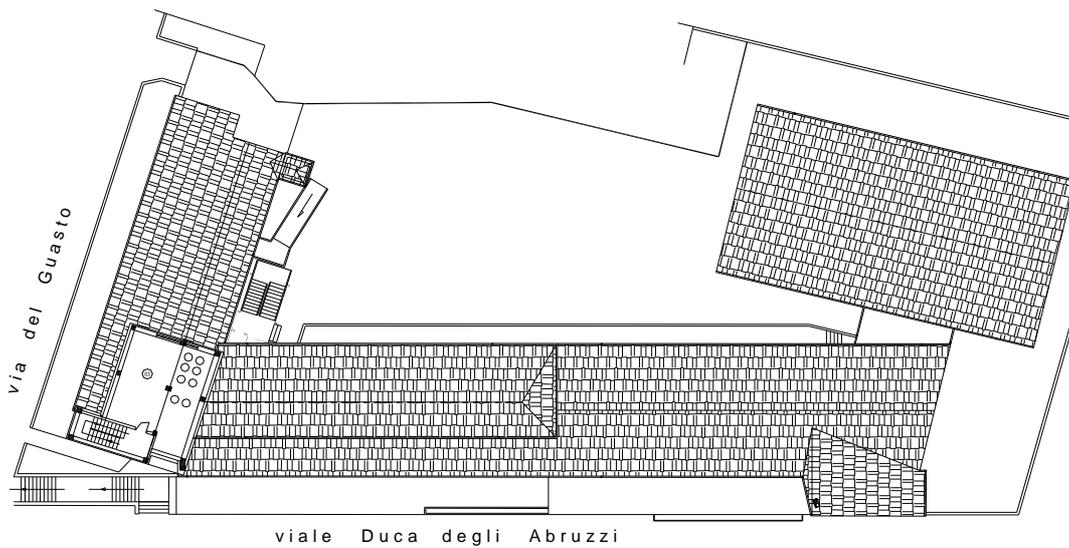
Pianta Piano Quarto (sottotetto).
